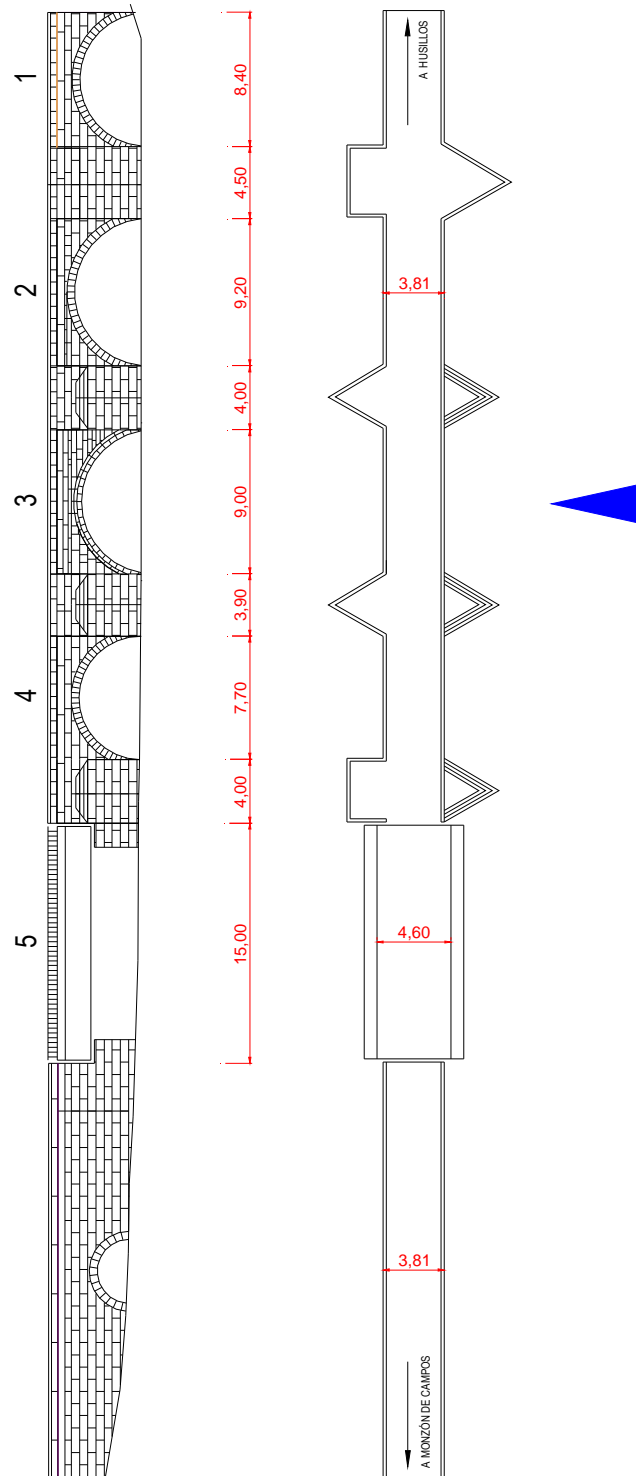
Planta y alzado de aguas arriba del puente en Husillos
